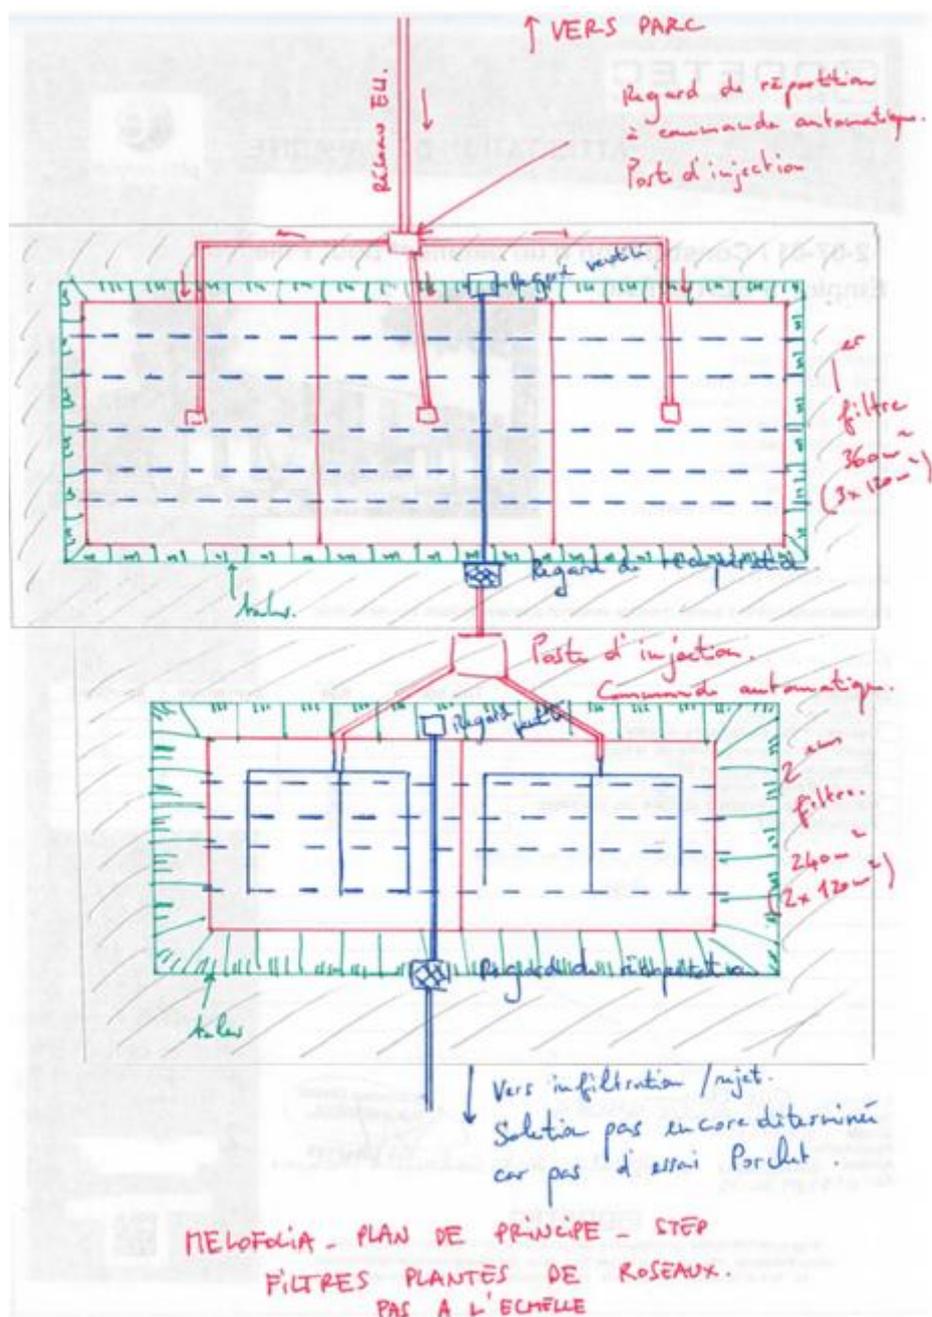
Fonctionnement général de la STEP : plan de principe (Source : Notice explicative – STEP en filtres plantés en roseaux – complément, mai 2023)
